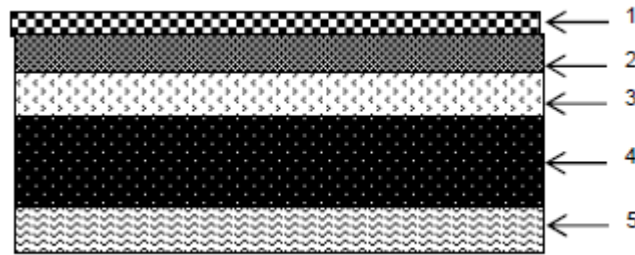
Coupe transversale d'un plancher en dalle pleine
